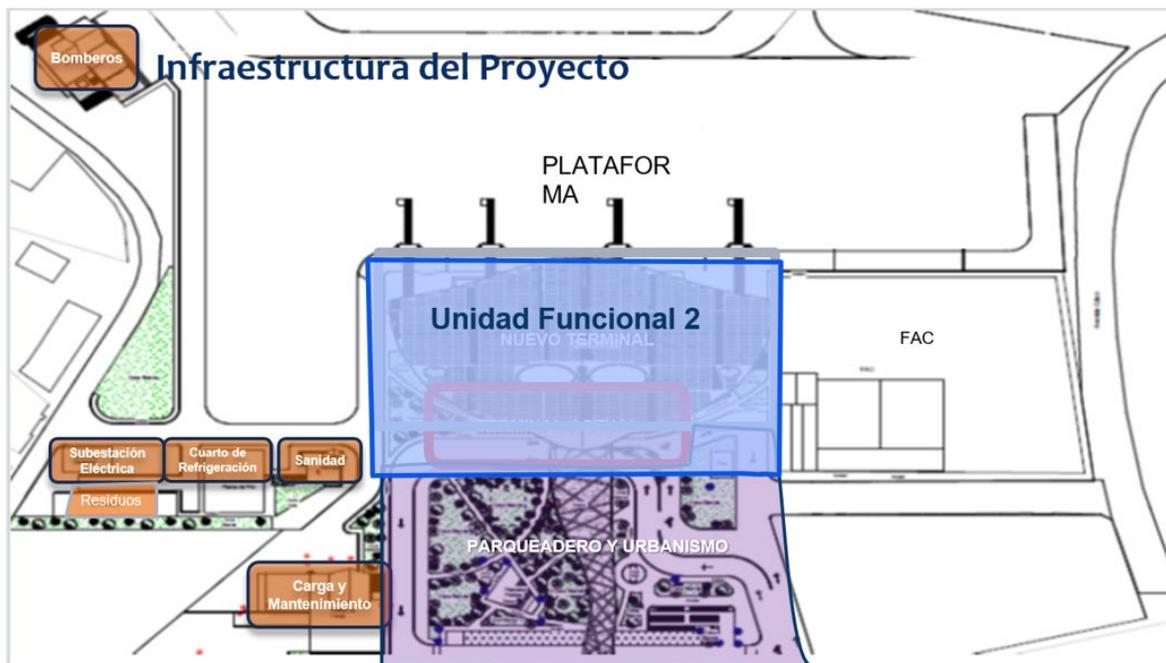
Planta Ubicación Edificio Técnicos de referencia
